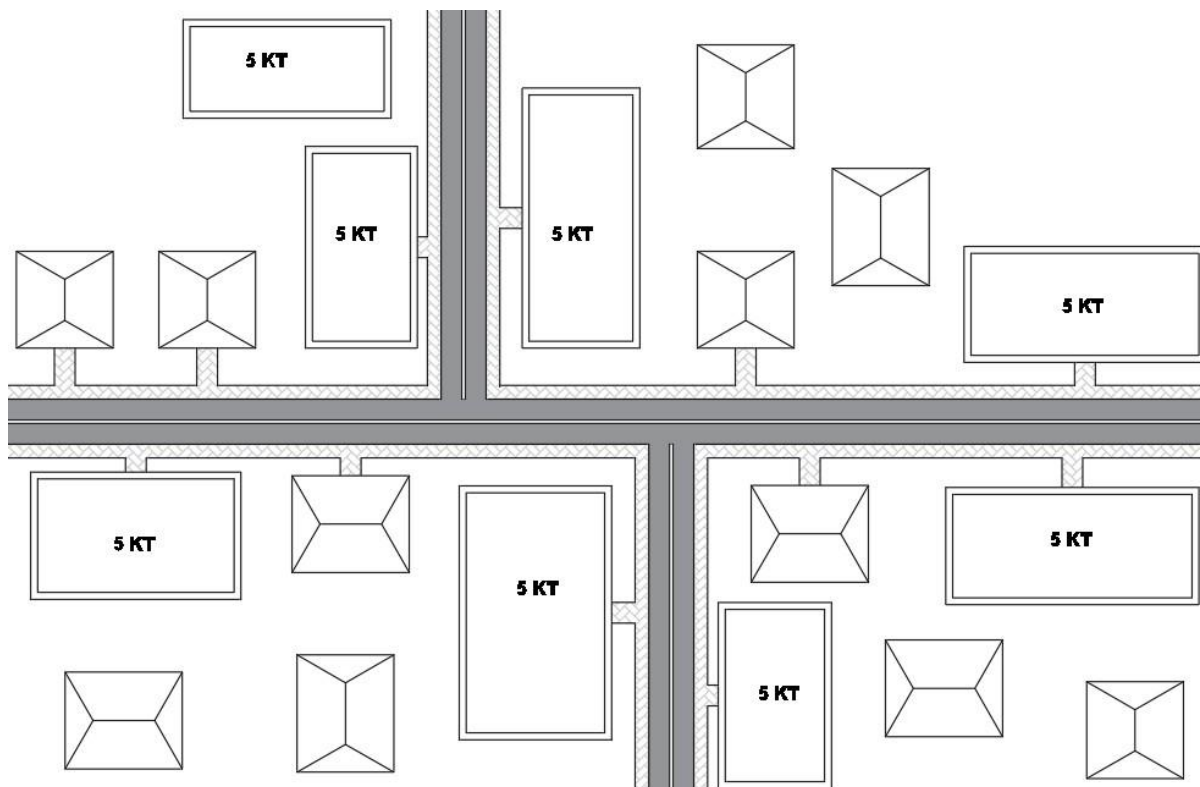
Model ilustrues i strukturave vila/pallat të grupuara
